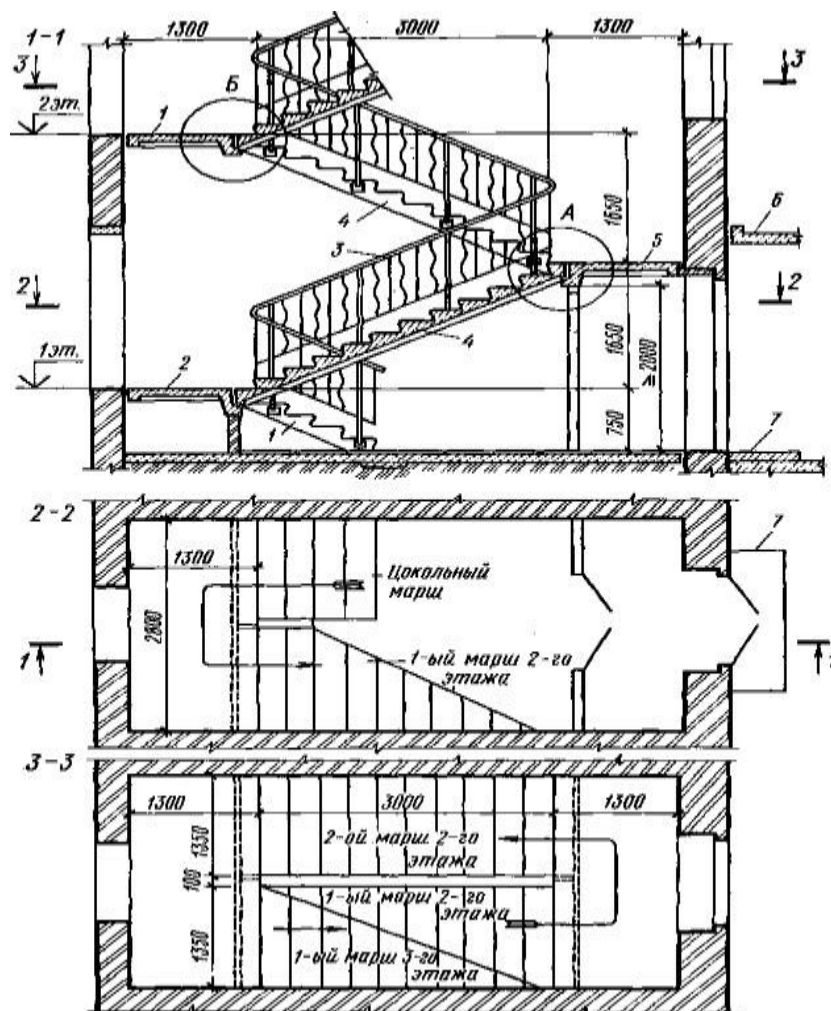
Двухмаршевая лестница (разрез и поэтажные планы):
